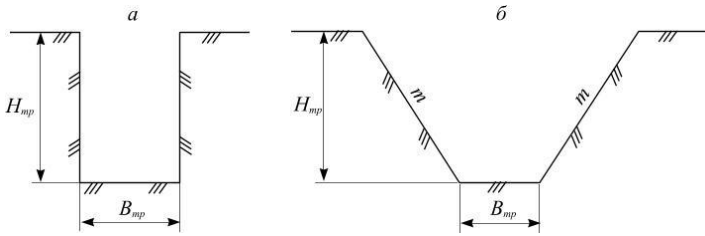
Схеми поперечного перетину траншей для трубопроводів:
